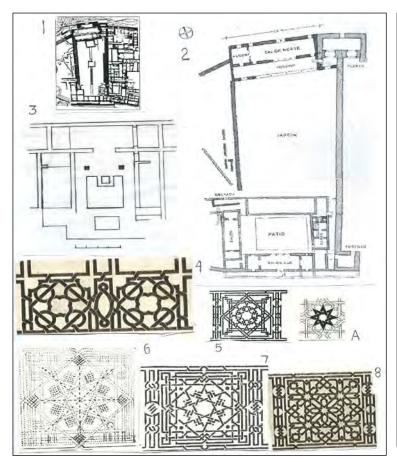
planimetrías de la alcazaba de Almería y zócalos árabes de la misma.
